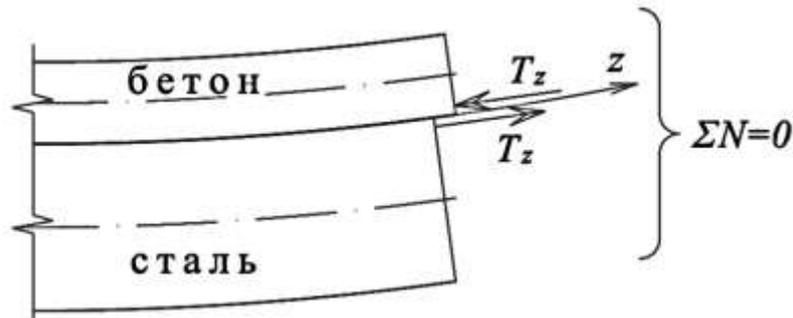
До визначення суми поздовжніх зусиль на поздовжню вісь стержня
